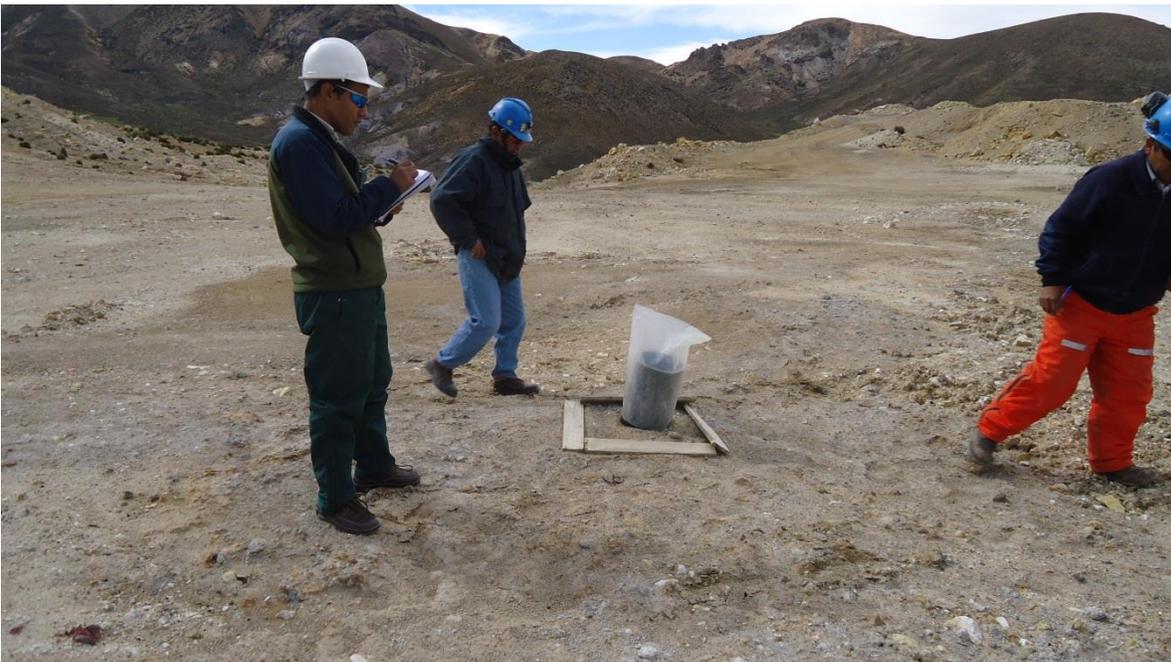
Muestra sondaje 2 con tubo de HDP de 8 pulgadas cubierto solo con una bolsa plástica.
